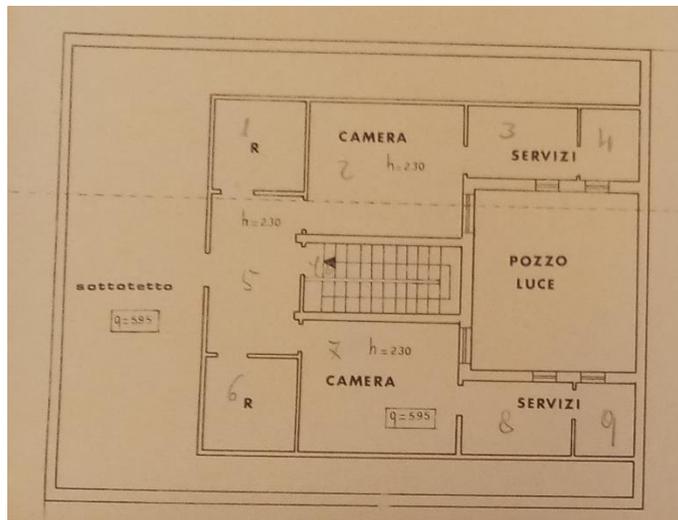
Planimetria stato attuale piano primo immobile 2 non completo
